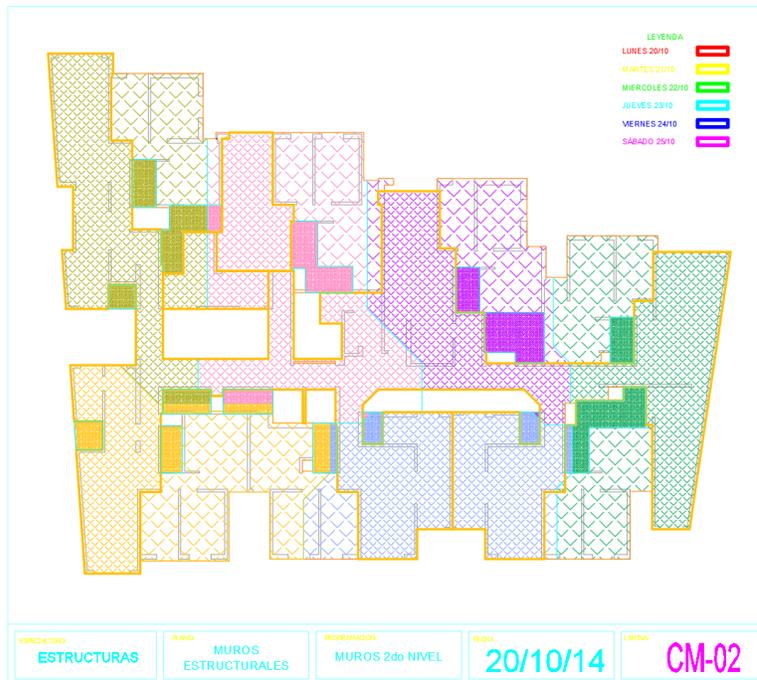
Sectorización de Colocación de Concreto en Losas. Fuente: Elaboración Propia
